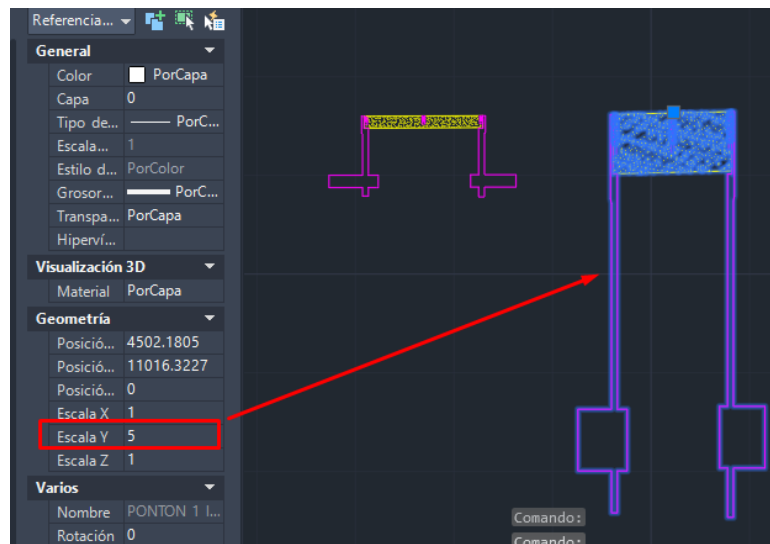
Bloque en planta Puente 1 El crucero - San Andrés de Pisimbalá
